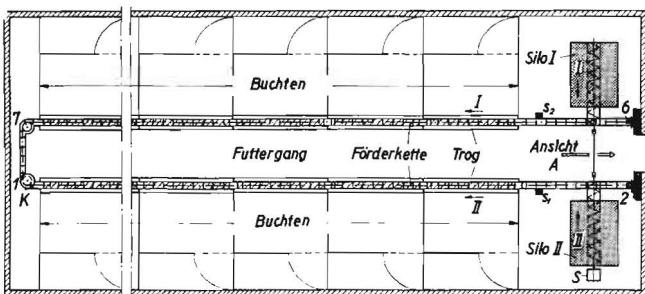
Grundriß des Schweinestalles mit schematisch angedeuteter Schrottdosieranlage
